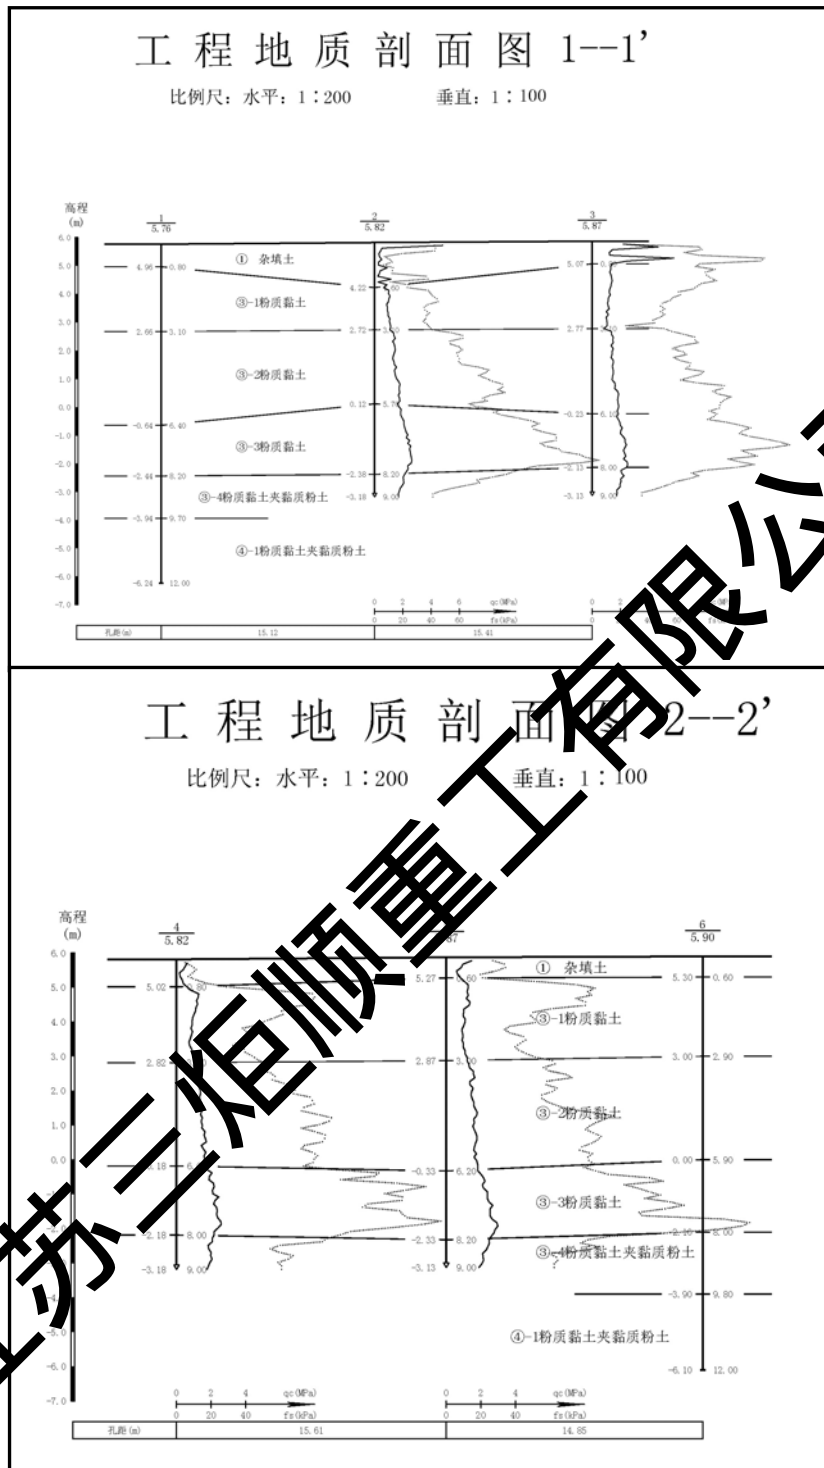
本项目所在区域勘测点工程地质剖面图
